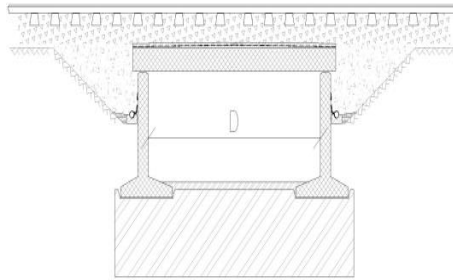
Exemplu de podet realizat din dale prefabricate din beton armat
